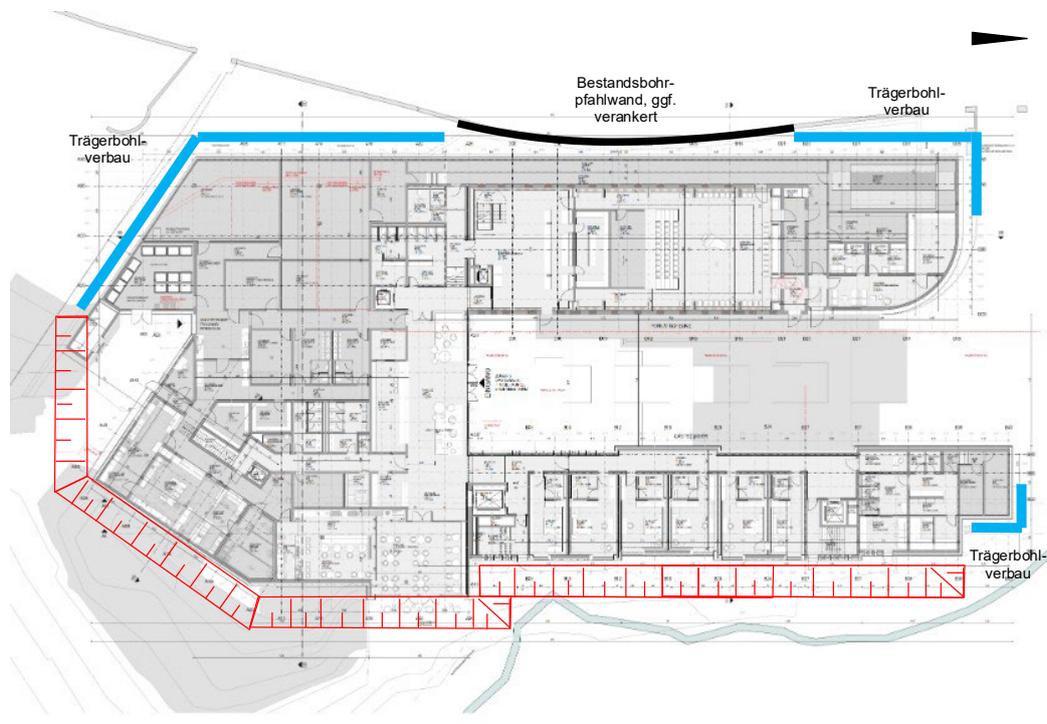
Lageplan Baugrubenempfehlung Ensemble
